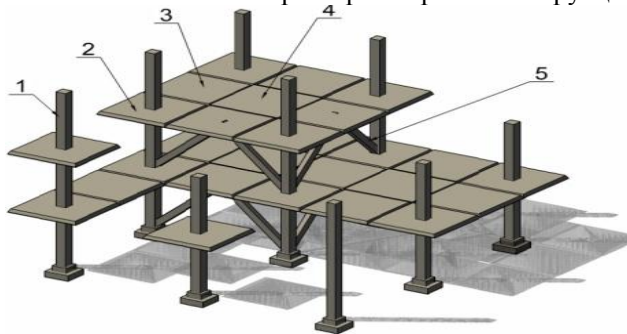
Схема безкапітельно-безбалкової конструктивної системи житлової будівлі: 1 – колона; 2 – надколонна плита; 3 – міжколонна плита; 4 – середня плита; 5 – елемент жорсткості
